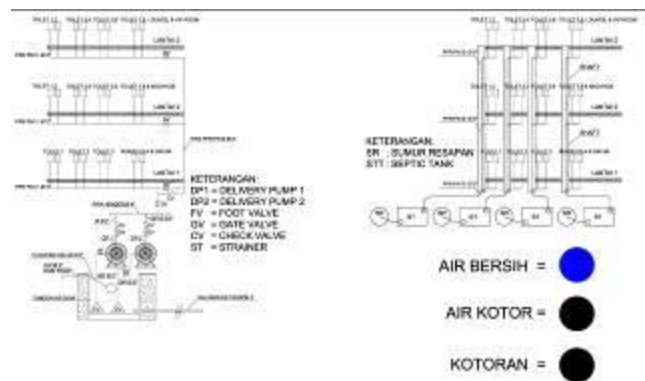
Fasilitas bangunan outdoor. Sumber: penulis.
